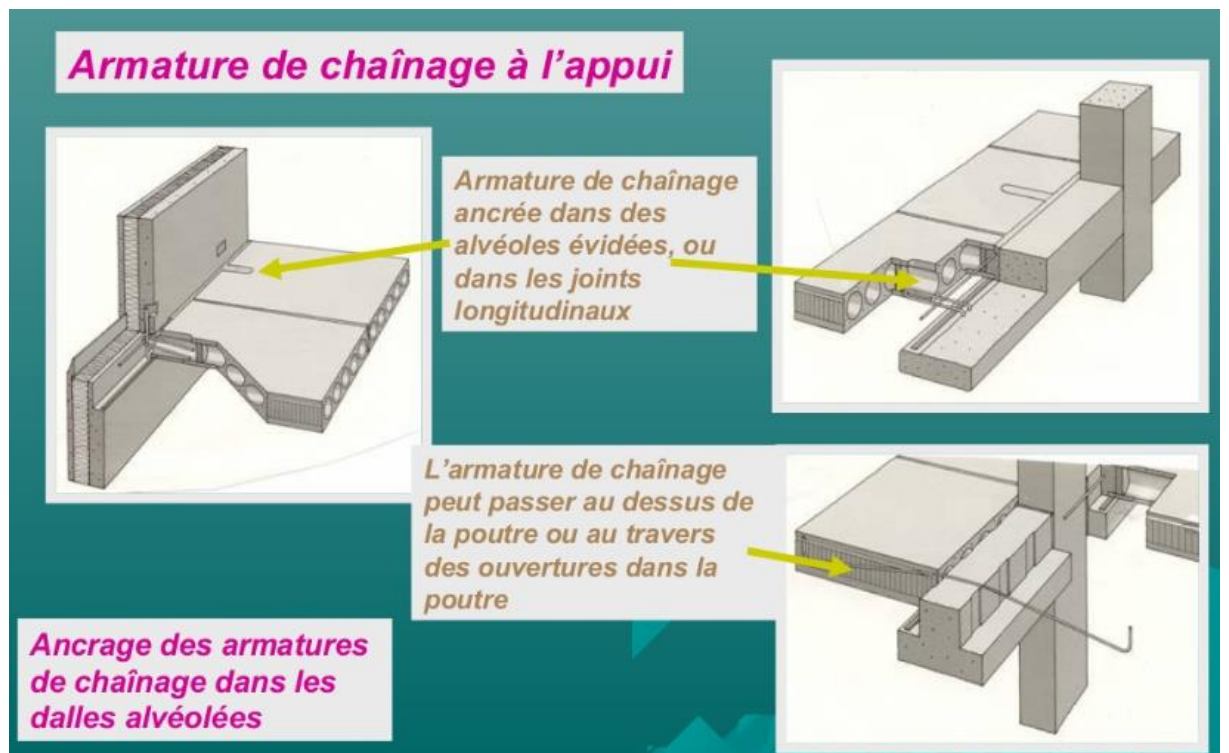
exemple d'assemblage de mur latéraux avec plancher
